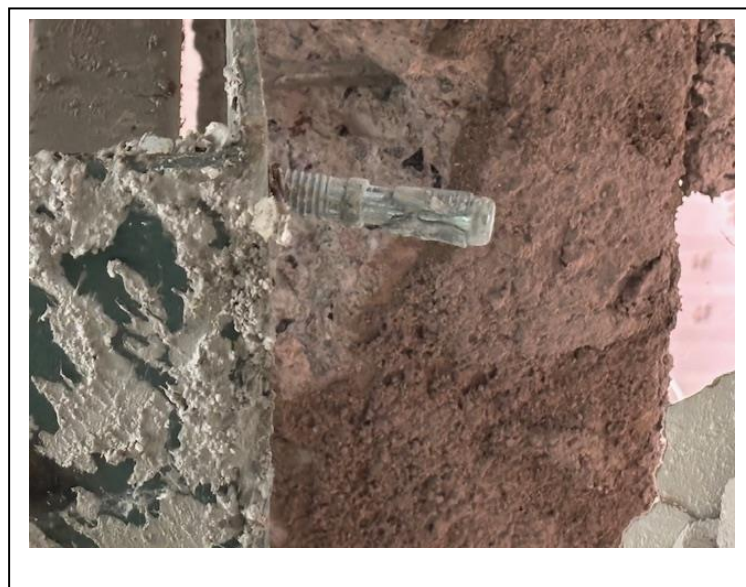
Parafuso da treliça metálica que desengastou da estrutura de concreto, ocasionando o dano.
